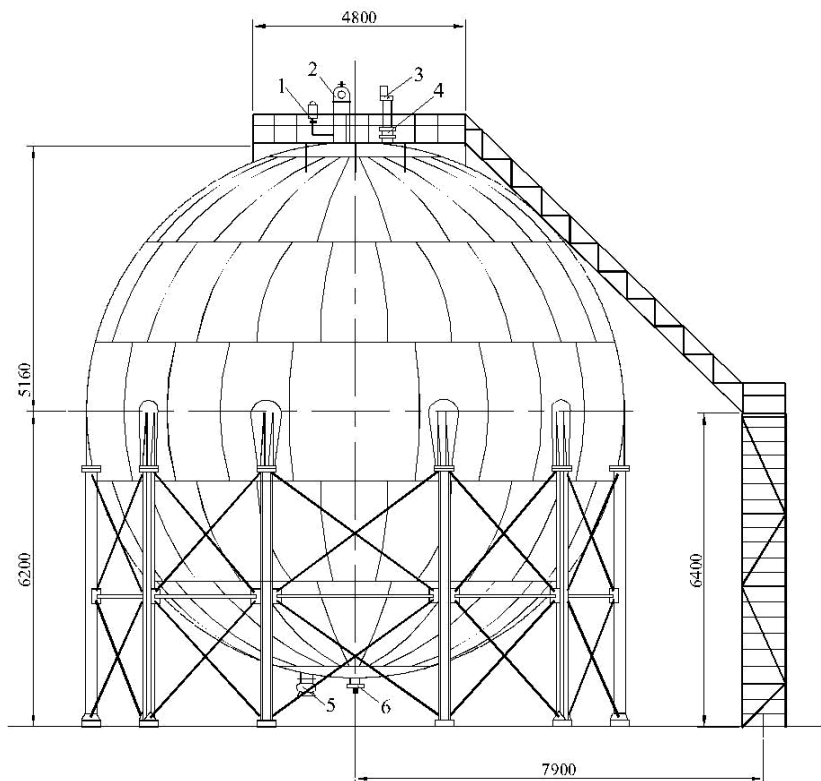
Шаровой резервуар емкостью 600 м³ с давлением 0,2 МПа:
